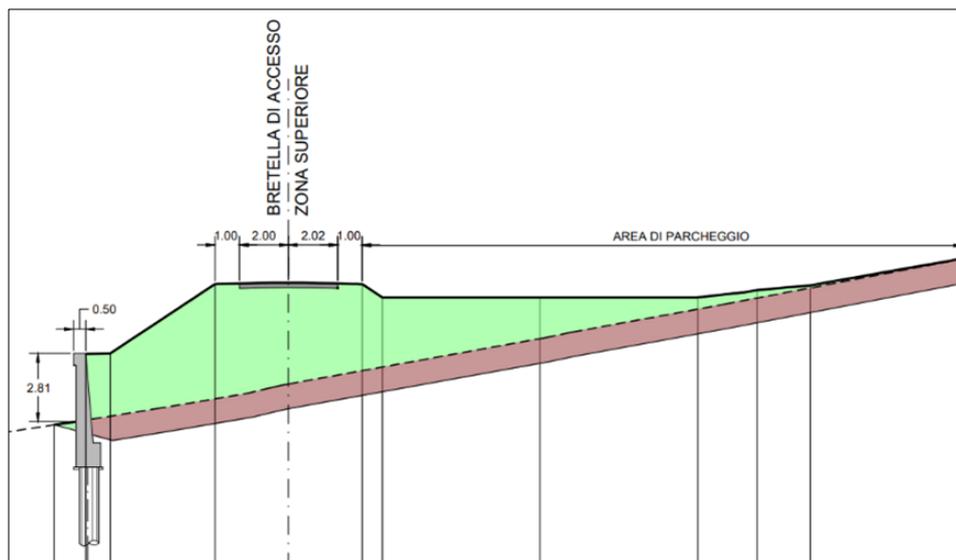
Sezione trasversale della rampa di accesso al piazzale di produzione con evidenza delle opere di sostegno da elaborato di progetto
